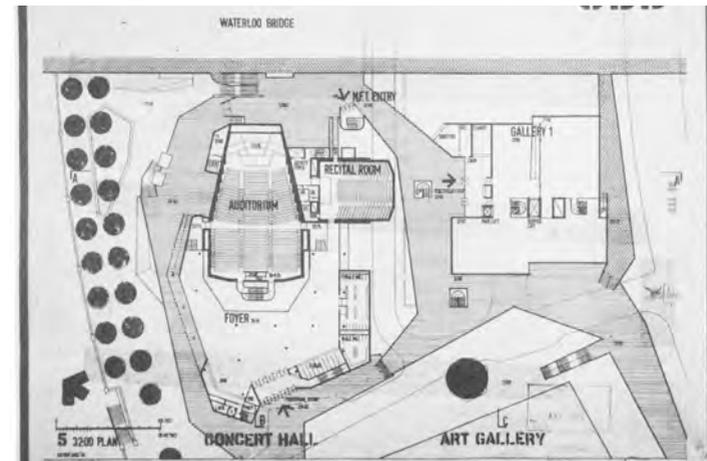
Pianta del South Bank Arts Centre, Londra, 1968, Copyright City of London, London Metropolitan Archives.
